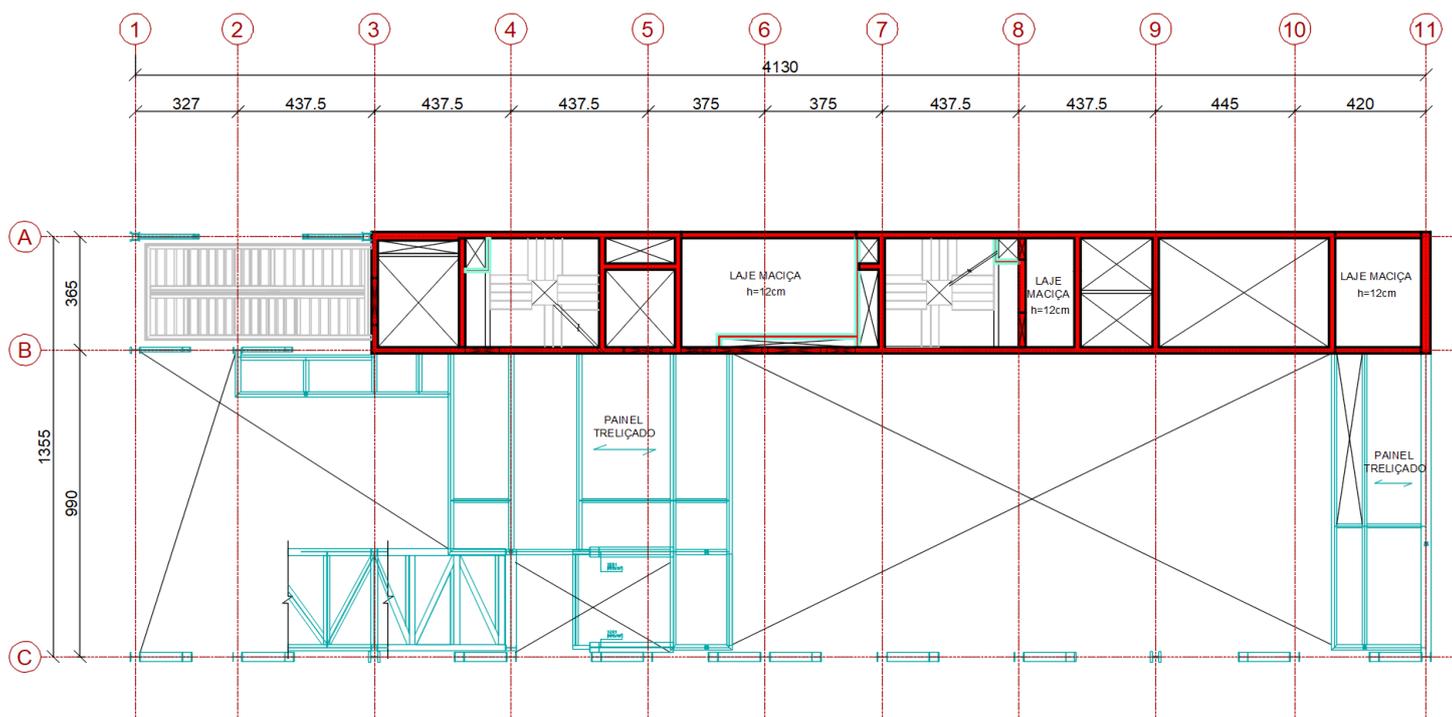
Planta de Arquitetura – Quarto pavimento: cabine de projeção
